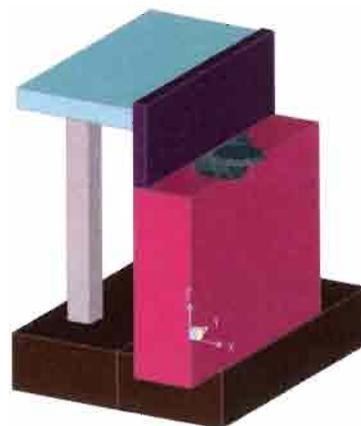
Modello di calcolo – vista estrusa degli elementi
